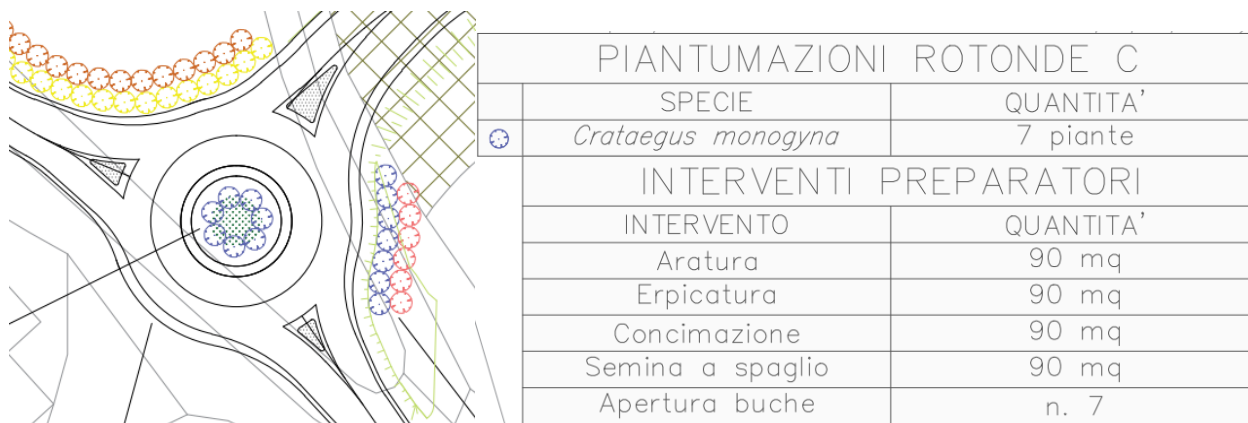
Estratto Elaborato P00_IA00_AMB_PP01 Planimetria opere a verde
